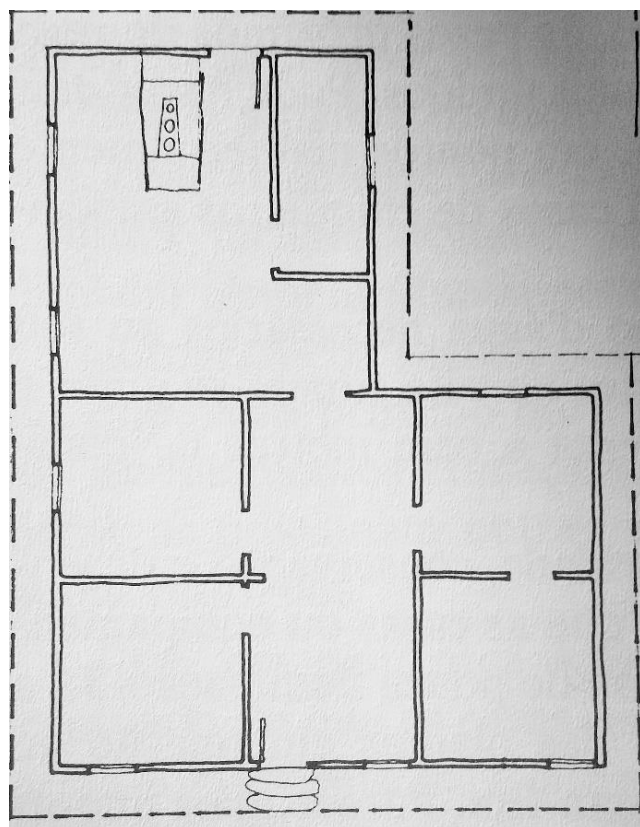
Planta baixa, da casa demolida de João Juca. Imagem: COSTA, 1994, p.90.
